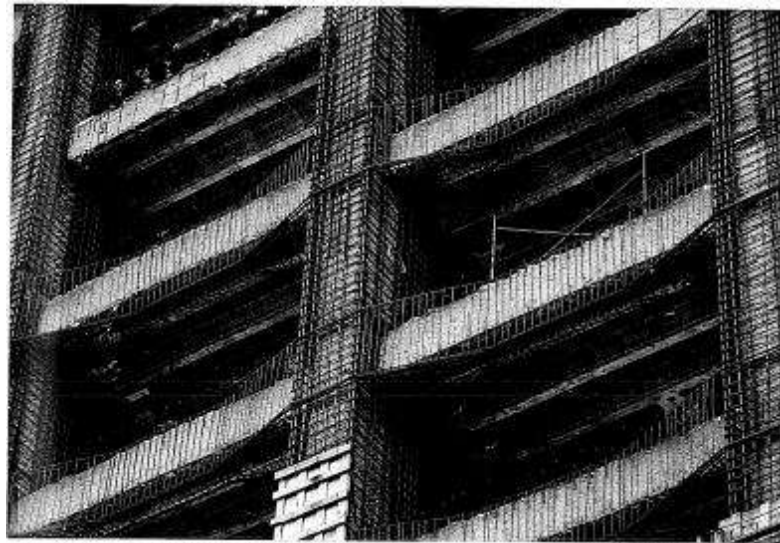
Encamisado de columnas y vigas (Aguilar, F. Breña, Jara, Iglesias, & Picado, 1996).
